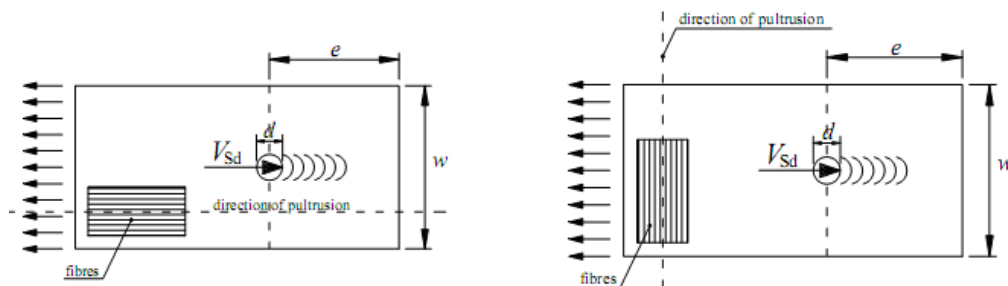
Fallo de aplastamiento o *bearing failure* para carga de tracción en la dirección de la pultrusión (a) y en la transversal (b).
